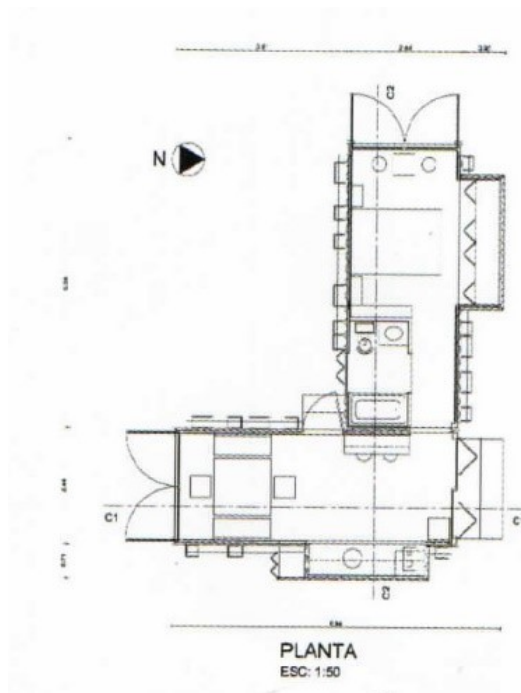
Planta Arquitectónica de la Vivienda modular Transformable
